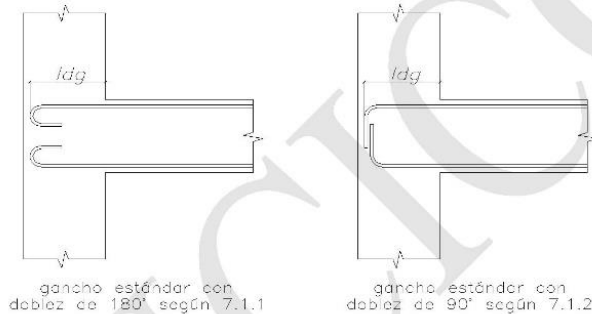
Longitud de anclaje con gancho estándar en tracción.
